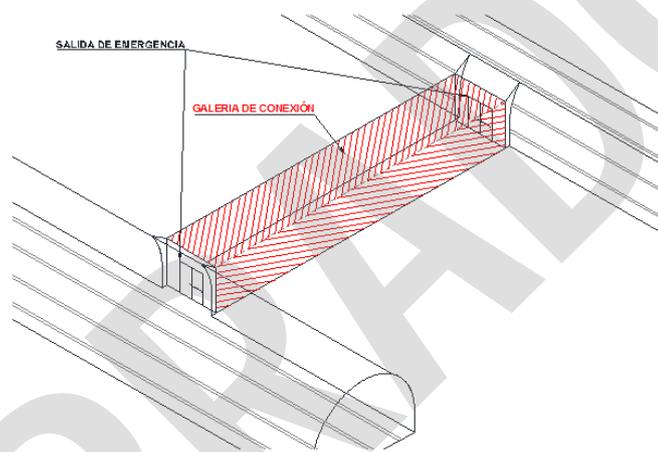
Ejemplo de galería de conexión entre túneles paralelos.
